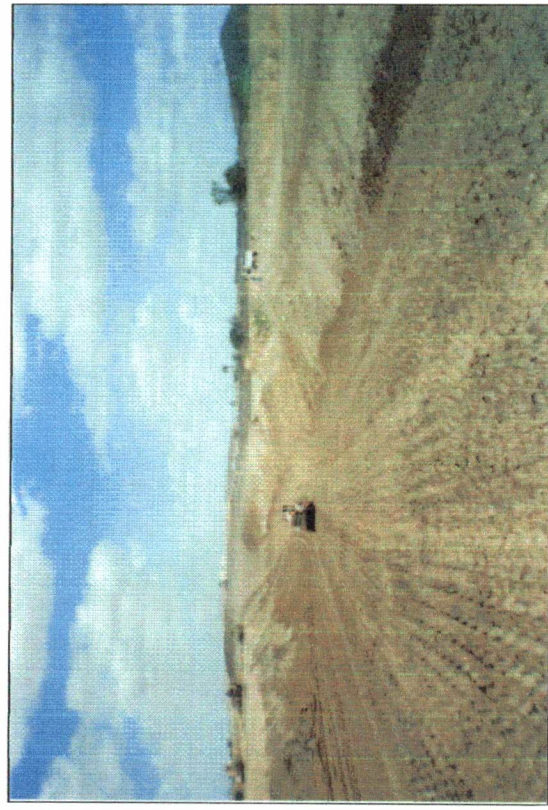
Vista panorâmica do preenchimento da parte central do cut-off (est. 39 à 43).
